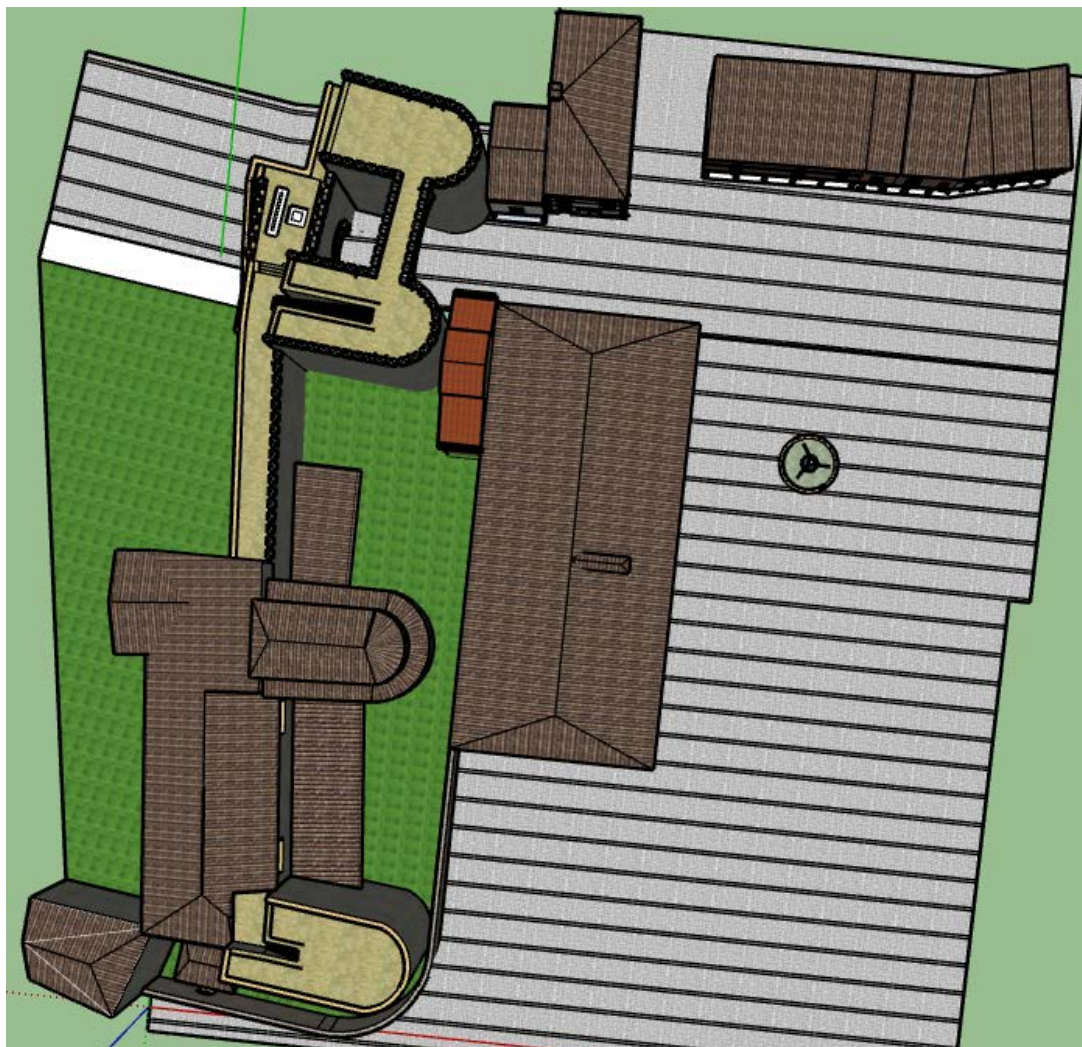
Vista en planta de la puerta de Alcázar, reconstrucción digital.
